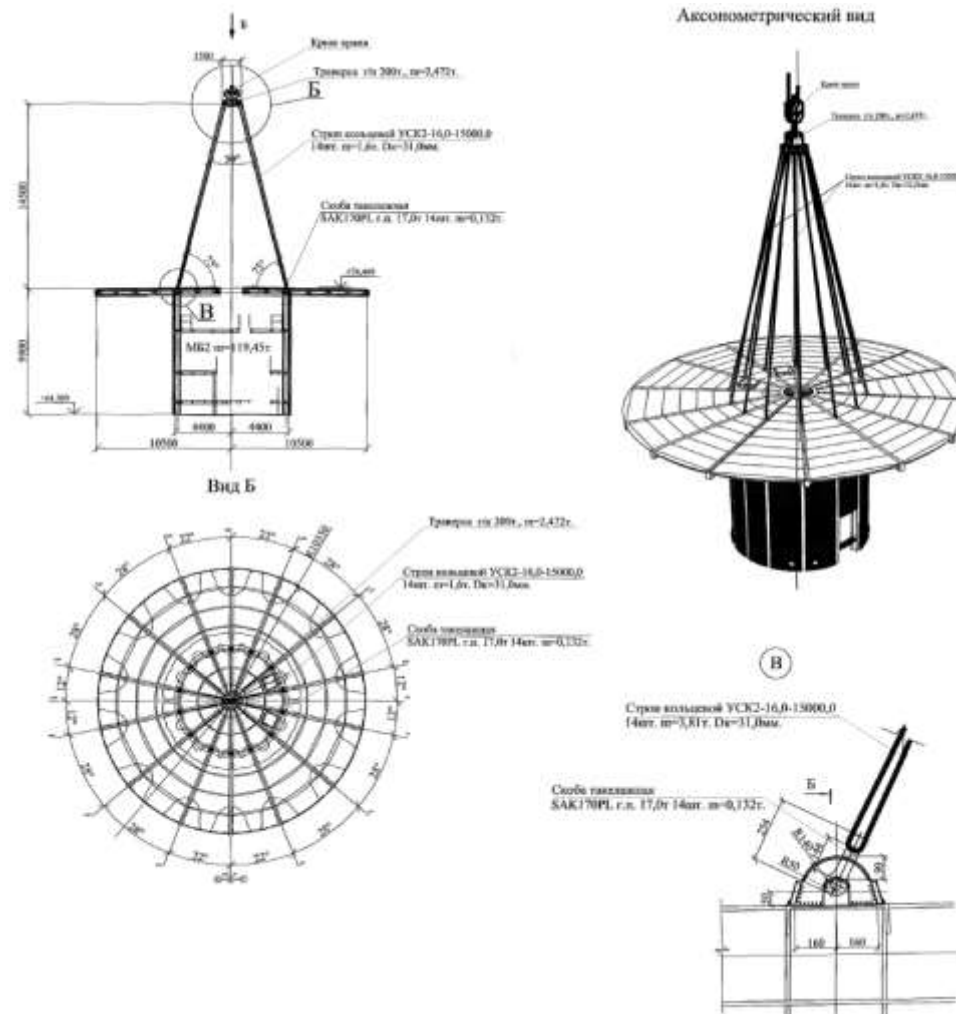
Схема стропки монтажного блока стальных строительных конструкций СПОТ (блок помещений фильтровальной установки) при монтаже
